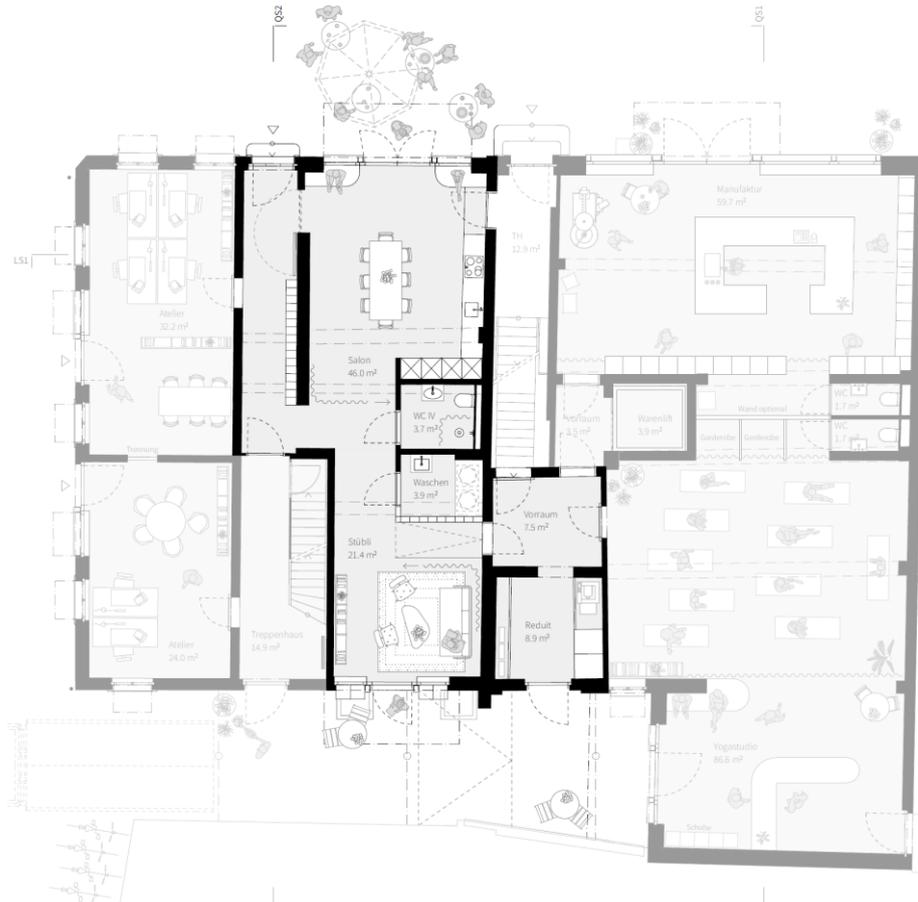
Erdgeschoss mit mittigen Gemeinschaftsflächen
